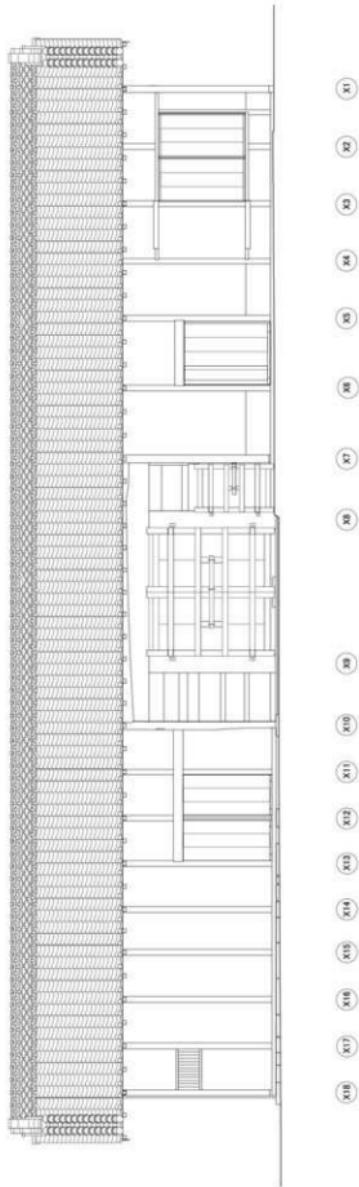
長屋門 竣工 西立面図 S=1/100
